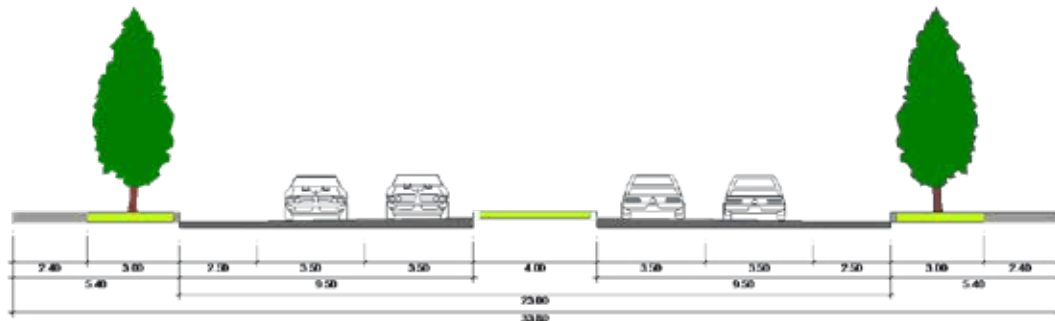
Sección transversal Isla 4,00 m y Acera con área verde.
